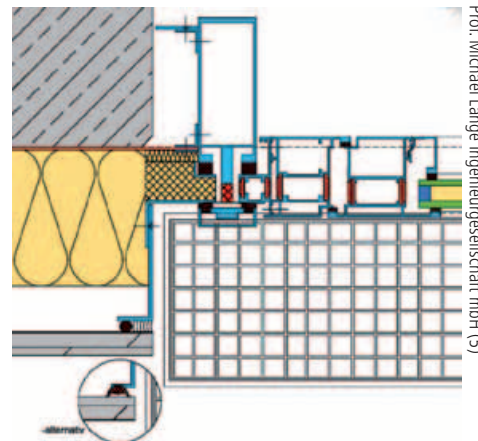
Seitlicher Anschluss einer Pfosten-/Riegelkonstruktion mit eingesetztem Wärmedämmstreifen und Leibungsblech zur definierten Abgrenzung zum Folgewerk.
